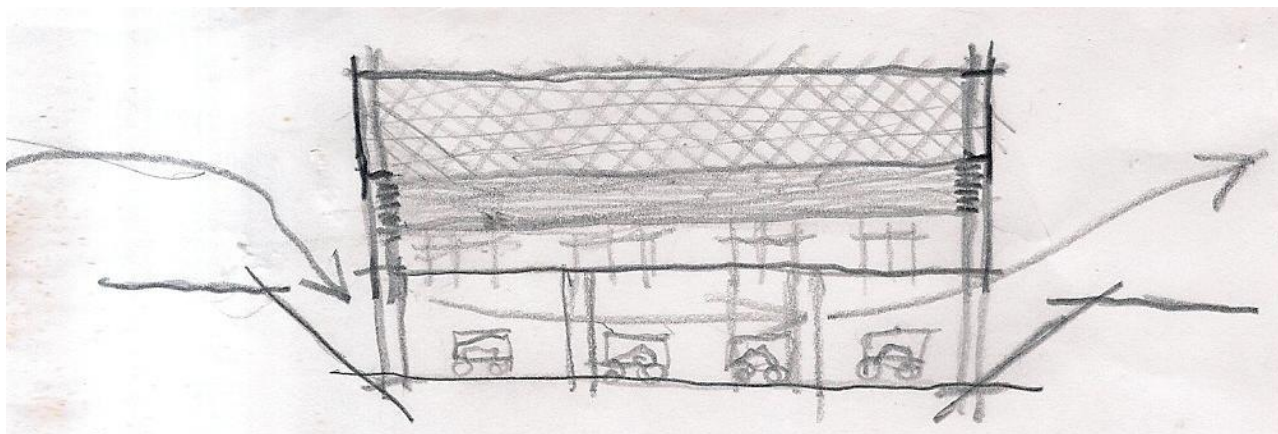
Croqui em corte mostrando sistema de ventilação do subsolo.
